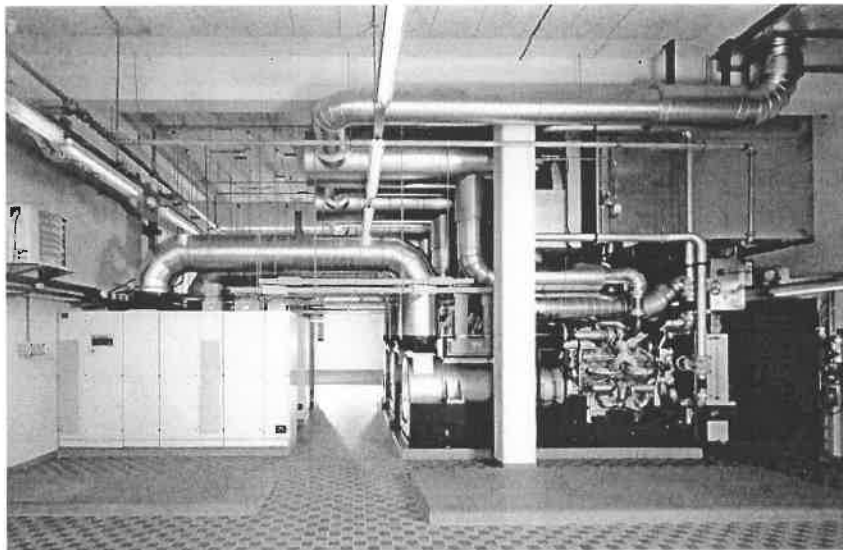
Impianto con tre gruppi in parallelo ridondante
